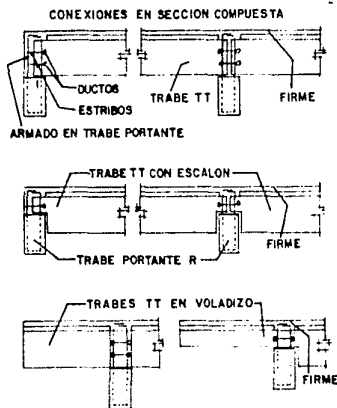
Conexiones en sección compuesta - (generalmente para entrepisos) de trabelosa "TT" con traves portantes de sección rectangular.
